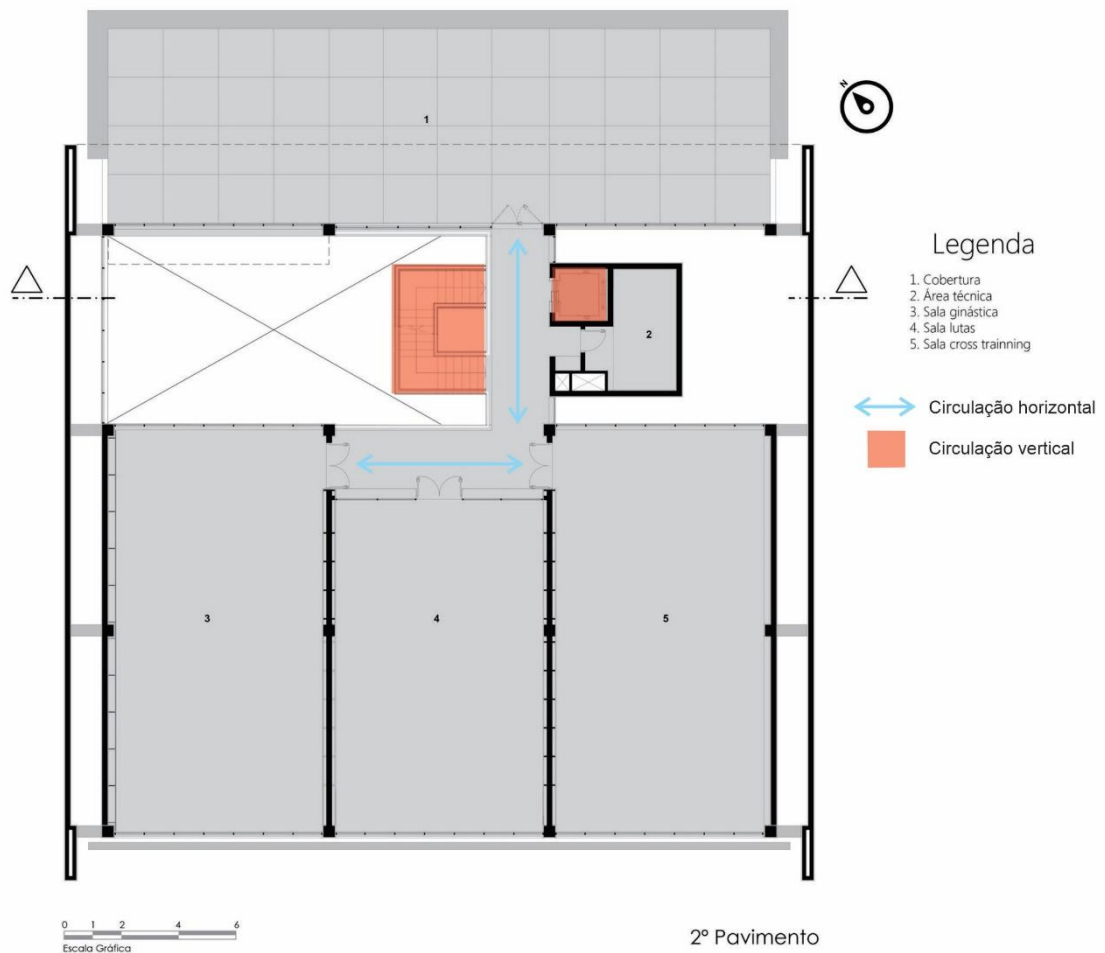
Planta baixa do 2º pavimento da academia Pulse Health & Fitness com indicação da circulação.
